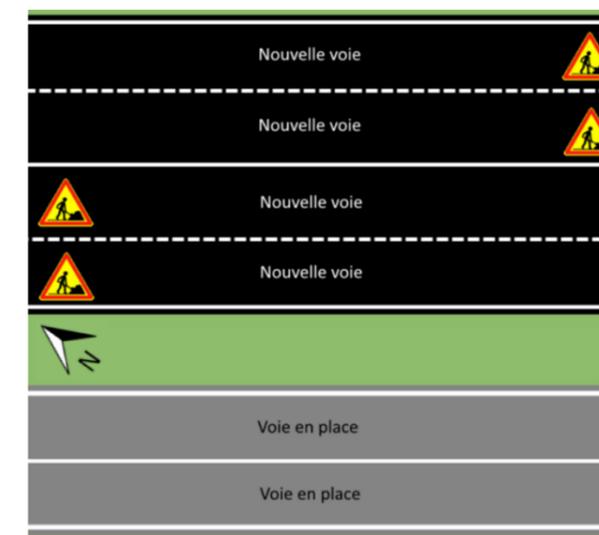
Principe d'un créneau distinct à l'est de de la chaussée actuelle
